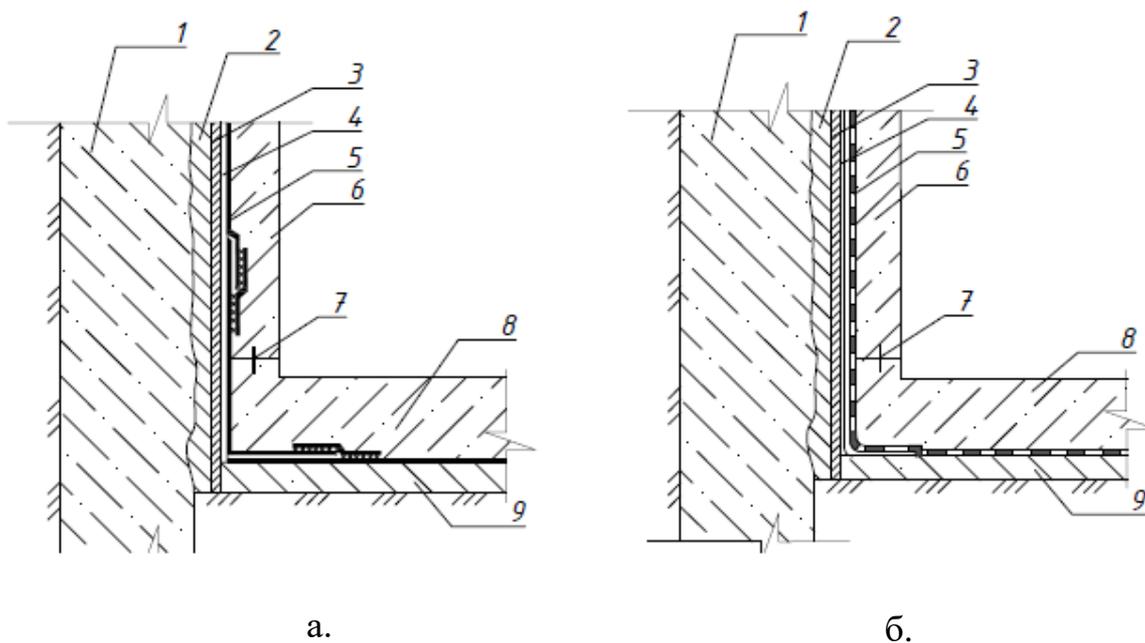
Гидроизоляция конструкций без пазух для обратной засыпки грунта.: а) с применением мембран, заводского изготовления, б) с применением листовой гидроизоляции с поверхностным слоем из напыляемых составов с двухсторонней адгезией.
